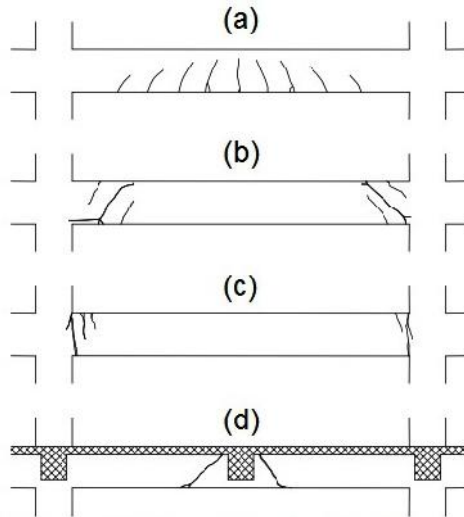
Danos comuns em vigas: (a) fissuras de flexão no vão; (b) fissuras de corte-flexão nos apoios; (c) fissuras de flexão nos apoios; (d) fissuras em apoios indiretos (Estêvão, 2012)
